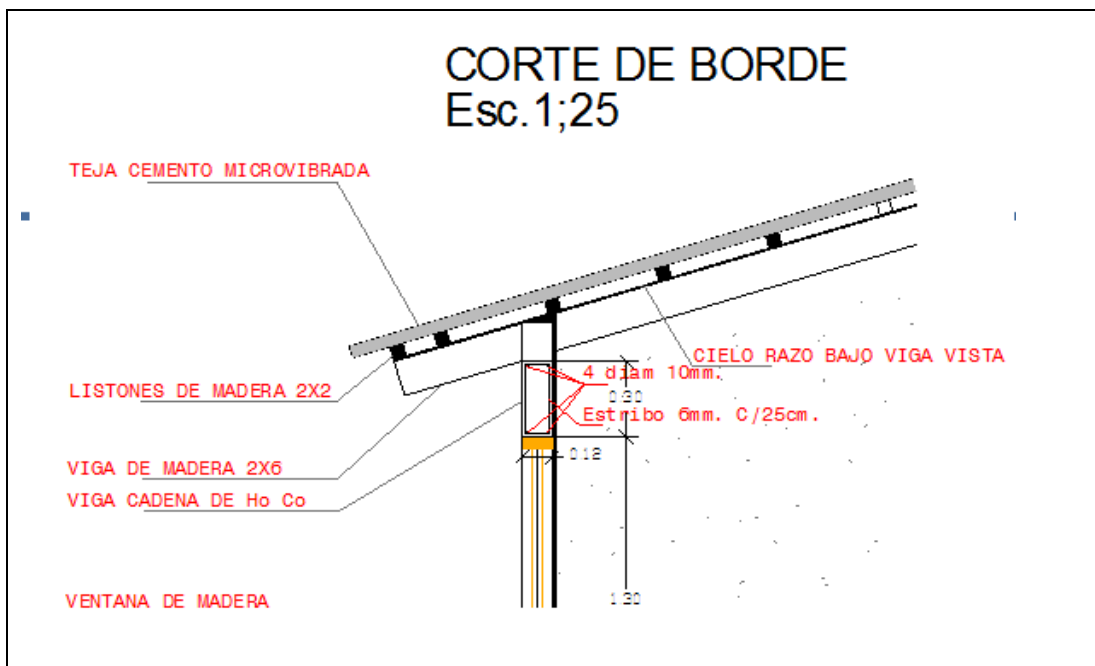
Detalle constructivo de cubierta con tijeras de madera.
